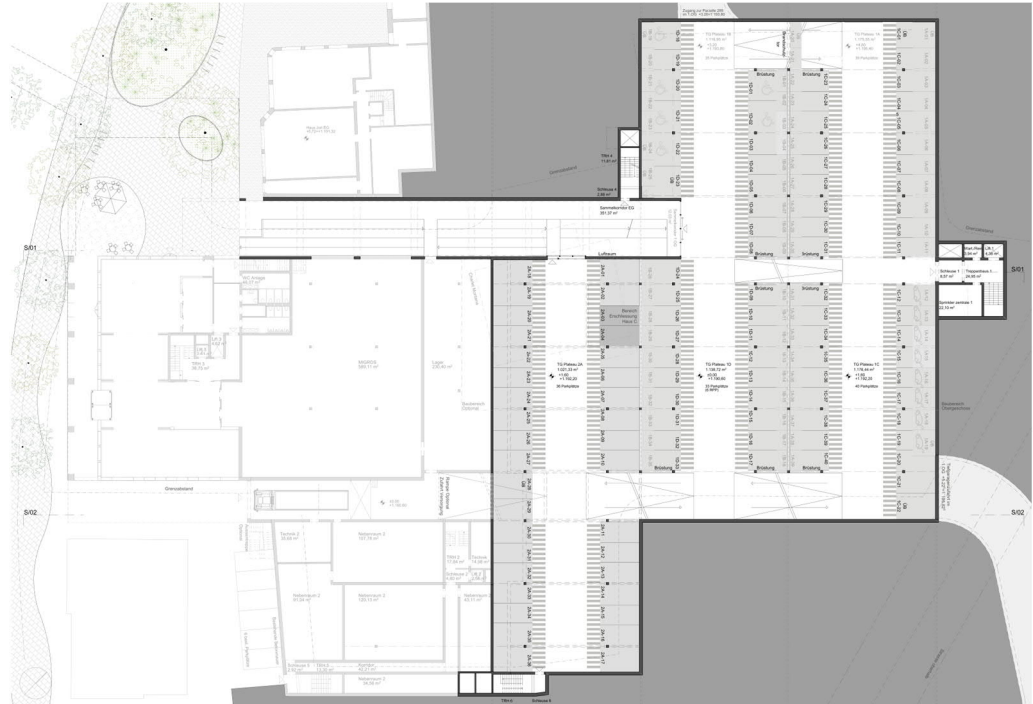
Erdgeschoss PULPO (massstabslos)
